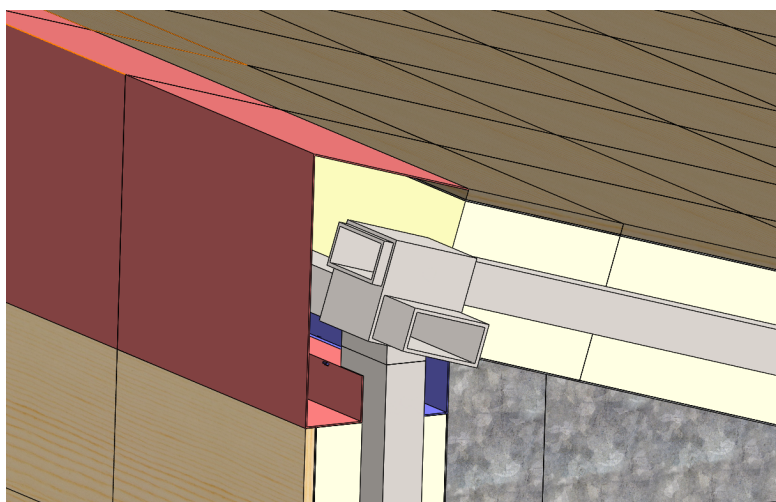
Tampas da ligação parede-teto da parede longitudinal superior.
